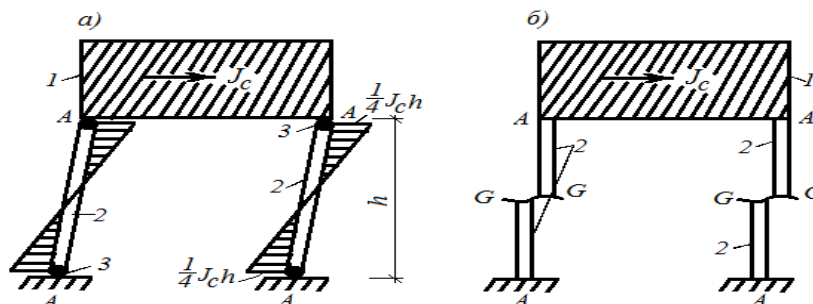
Расчетная схема (а) и схема разрушения (б) здания с гибкими 1 этажом
